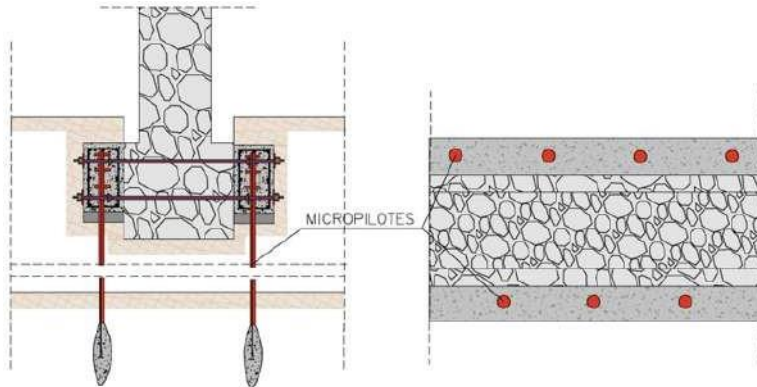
Refuerzo zapata corrida bajo muro. Tipo 2. Micropilotes. Fuente propia
